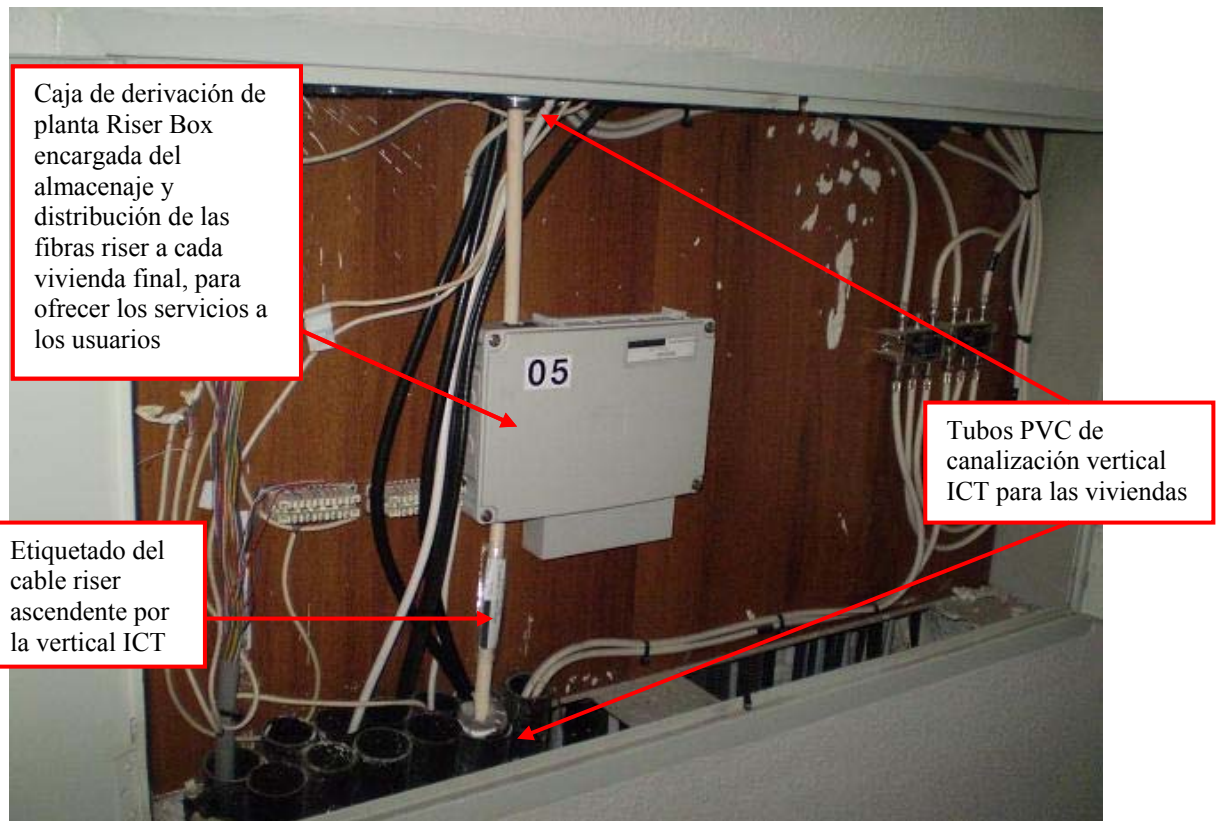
Vista de puerta de acceso al patinillo de canalización ICT vertical de las viviendas (planta 5ª)
